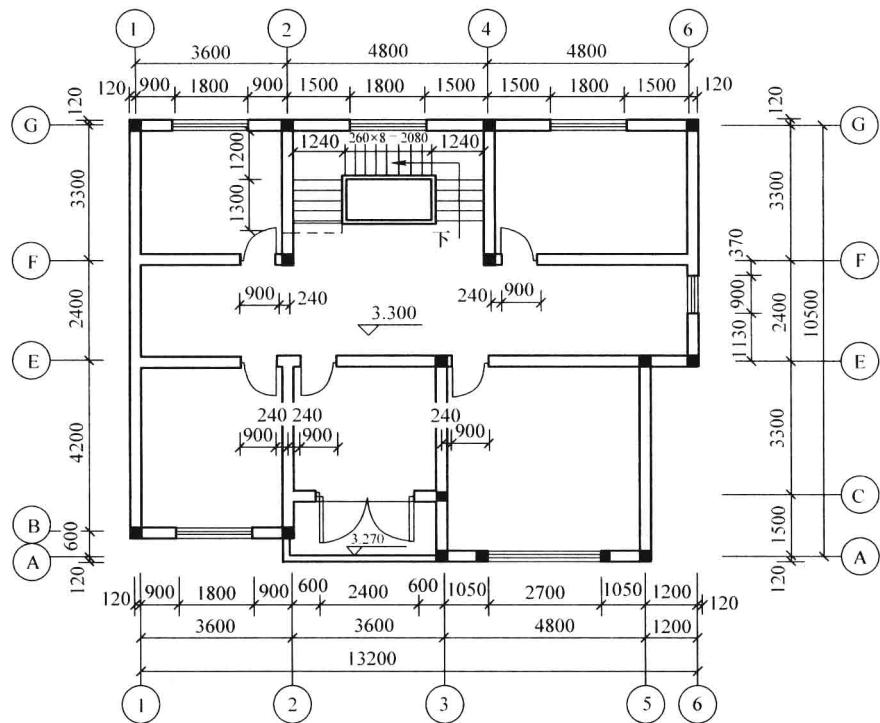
二层平面图（墙体厚 240mm，轴线居中）
